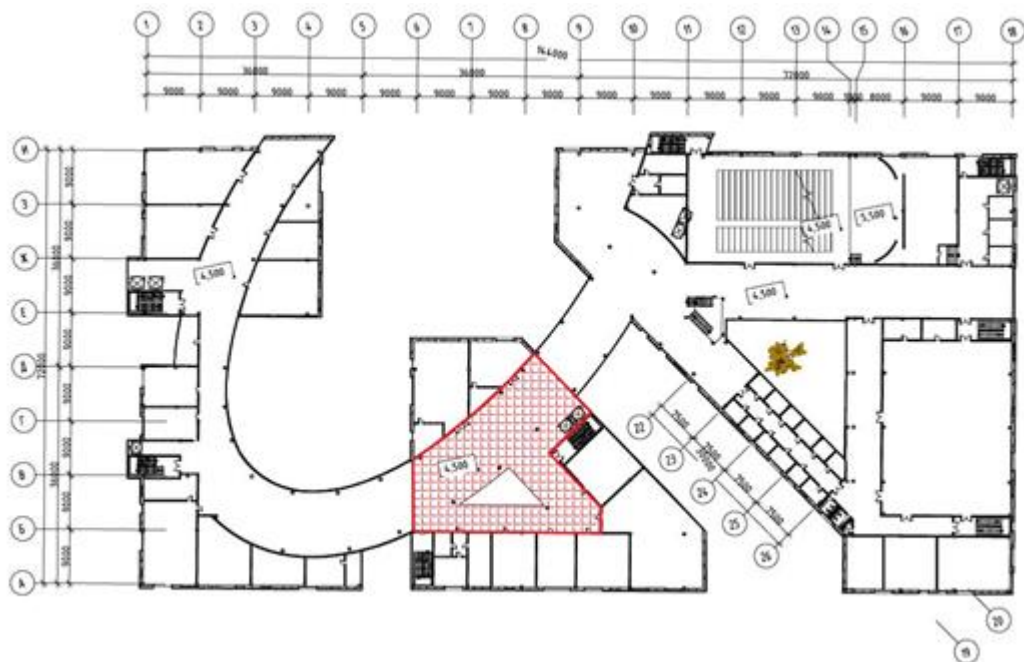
План другого поверху на відм. +4,500 - зона влаштування кесонного перекриття.
